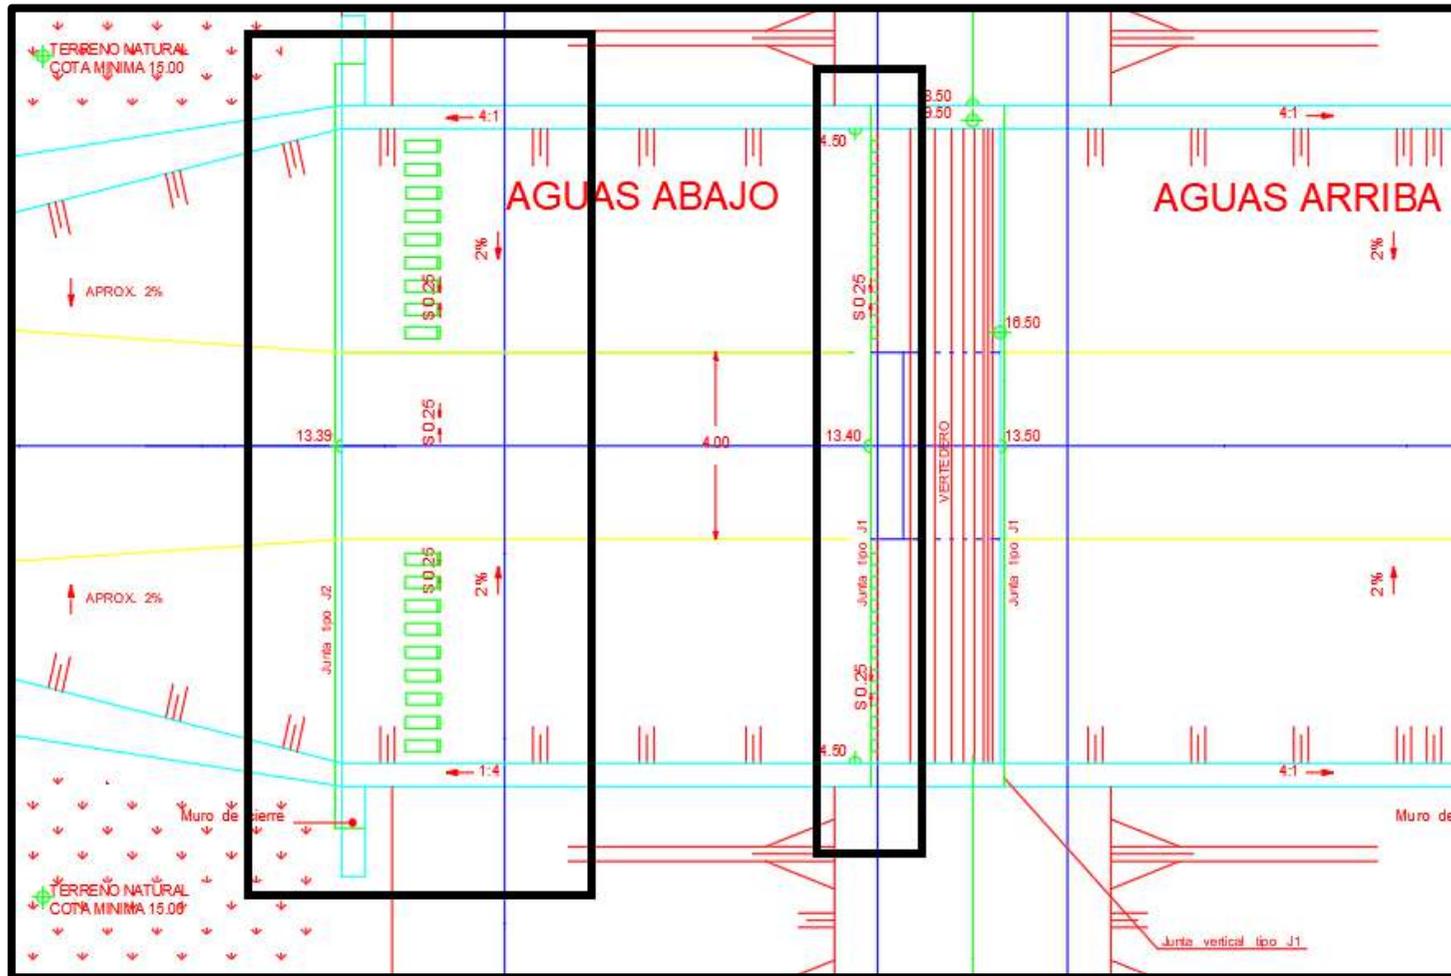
Planimetría de Distribución de Dientes de Amortiguación
